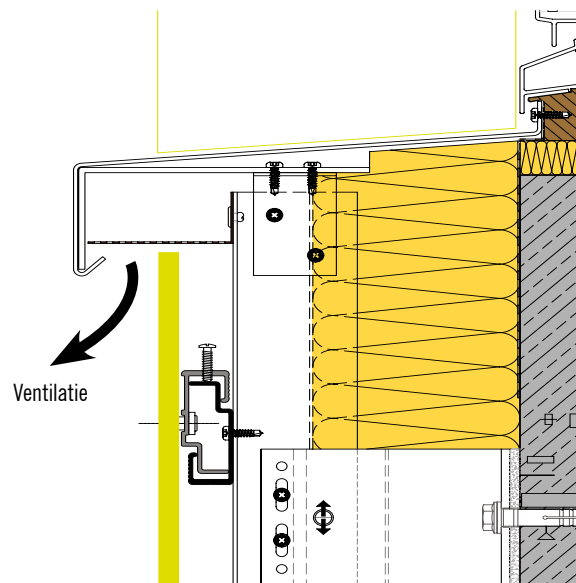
DETAILLERING: VERTICALE DOORSNEDES SYSTEEM PM03
